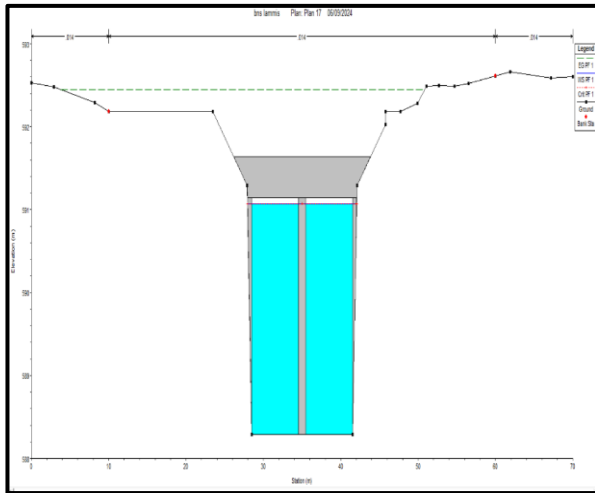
Section transversale des dalots au Pont N°1 (Oued Alyem)
